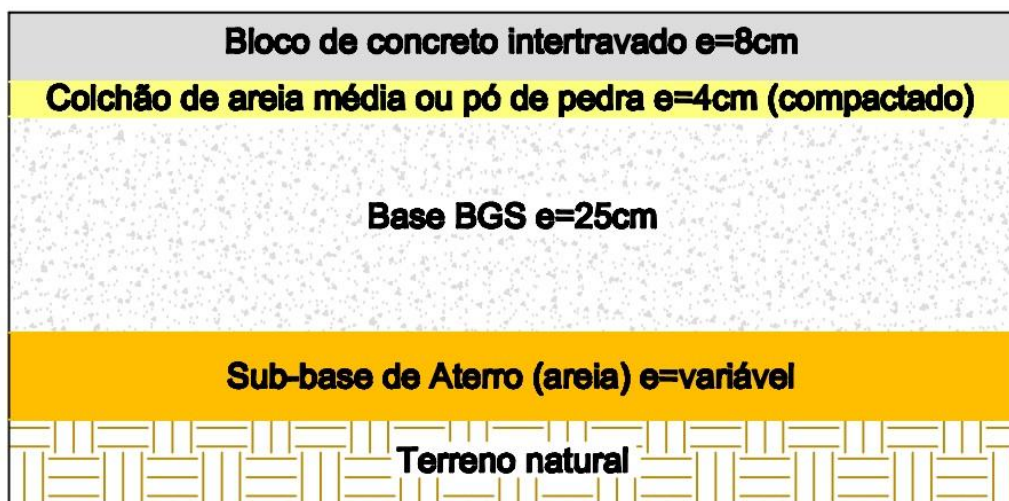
Camadas do pavimento de bloco de concreto intertravado
